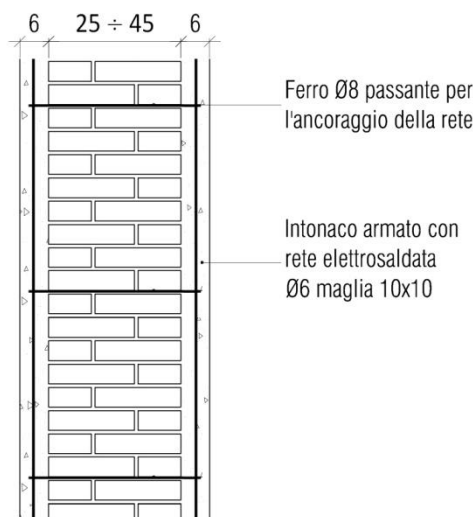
Dettaglio in sezione dell'intonaco armato per la tipologia MUR2
